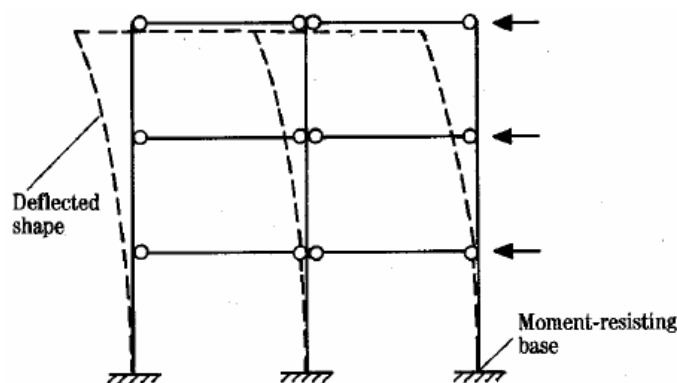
Configuração da deformada de uma estrutura não contraventada (Arnold, 2002)
